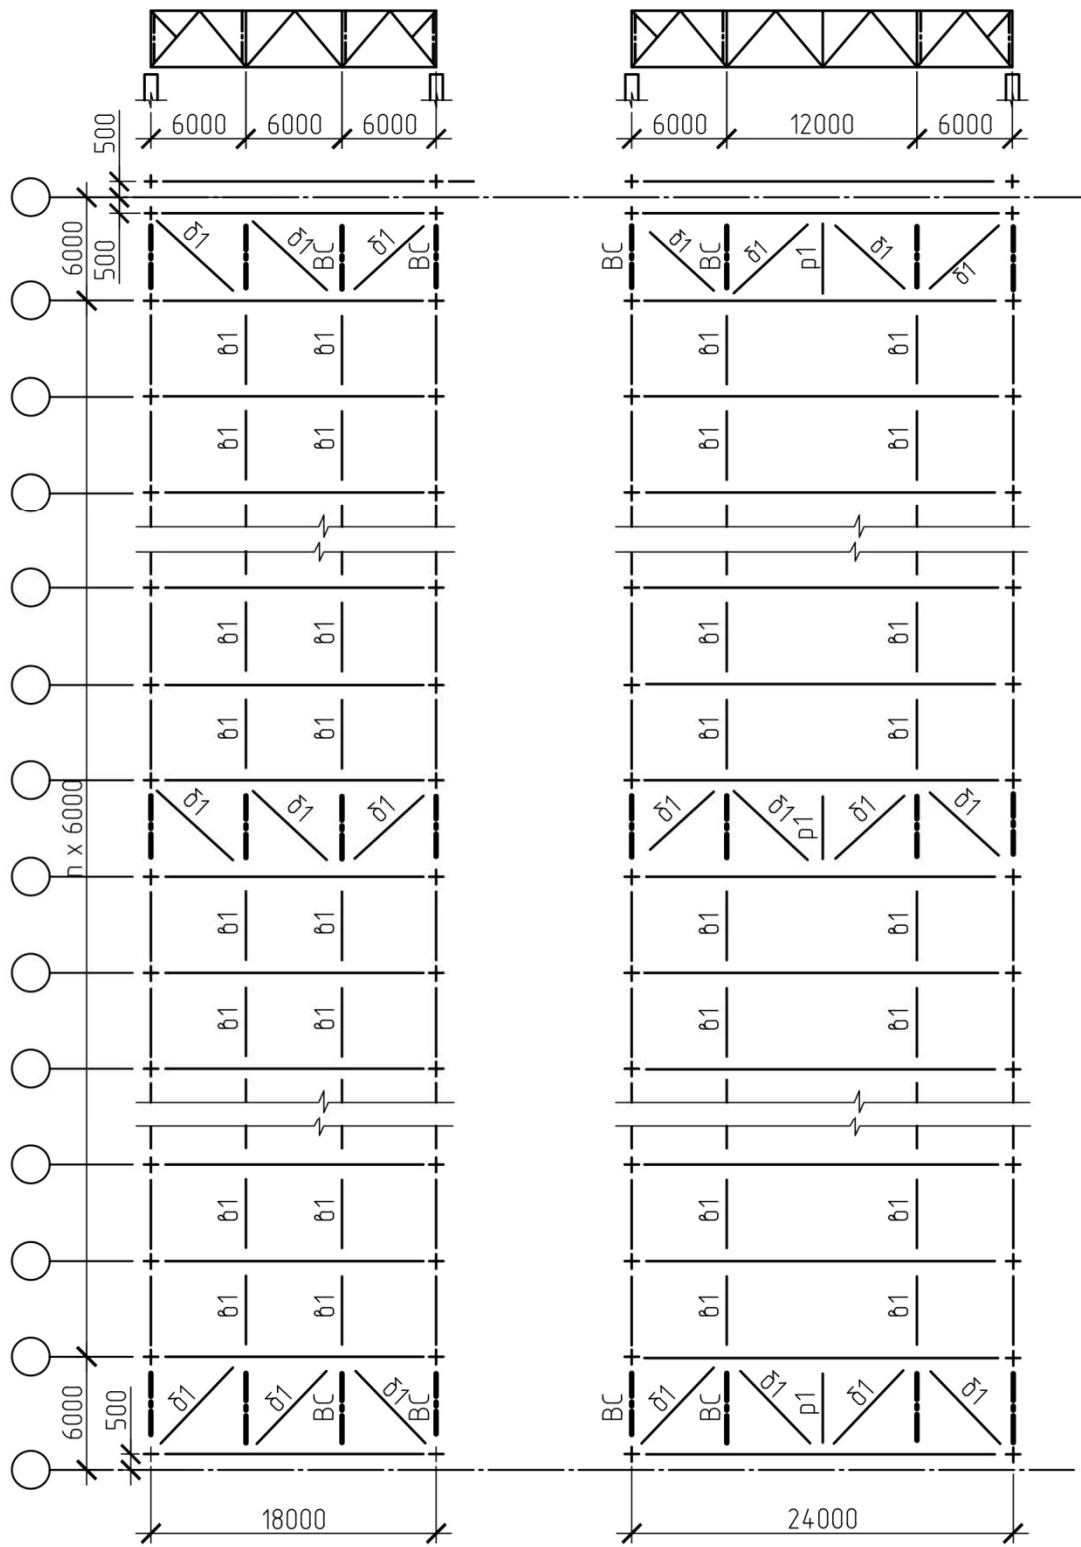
Схемы расположения связей II типа по нижним поясам стропильных ферм, шаг ферм 6 м, пролеты 18 и 24 метра
